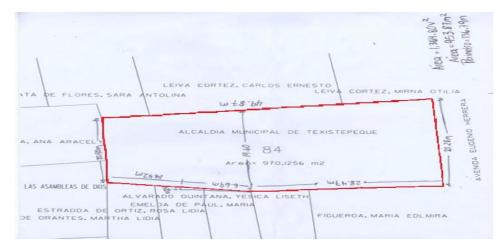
Plano a mano alzada del terreno en el que se construirá el centro.
